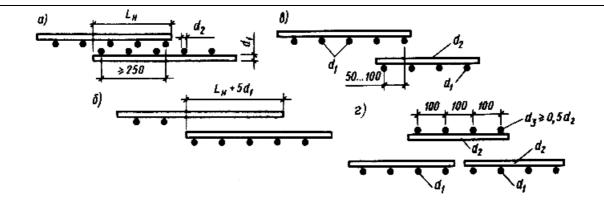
Соединение сварных сеток нахлесткой:
